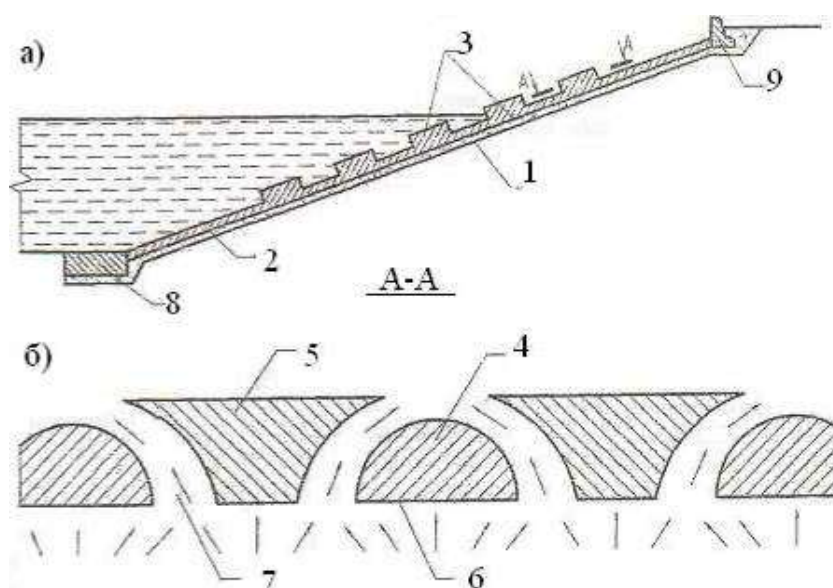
Покрытие верхового откоса по патенту 2320808: а – профиль покрытия; б – сечение волногасящих элементов; 1 – верховой откос; 2 – монолитное железобетонное покрытие; 3 – ряды волногасящих элементов; 4 – полуовальные детали; 5 – клиновидные детали; 6 – основание полуовальных деталей; 7 – потокосоударяющие каналы; 8 – упорная плита; 9 – волнобойная стенка
